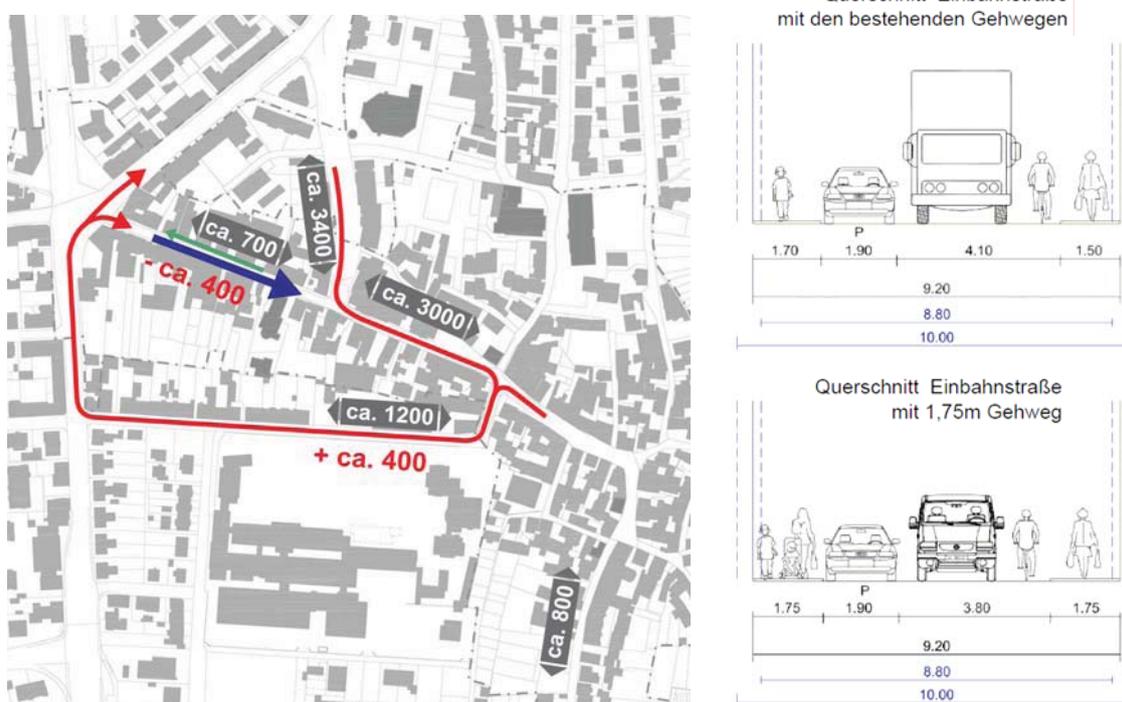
Einbahnstraße Rathausstraße West / Querschnitte
